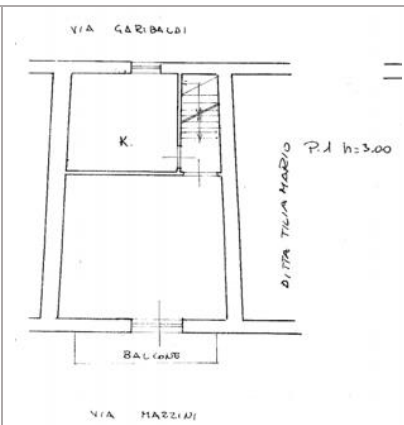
planimetria catastale Fg.10 Part.614 Sub.2 (abitazione - Piano Primo)
